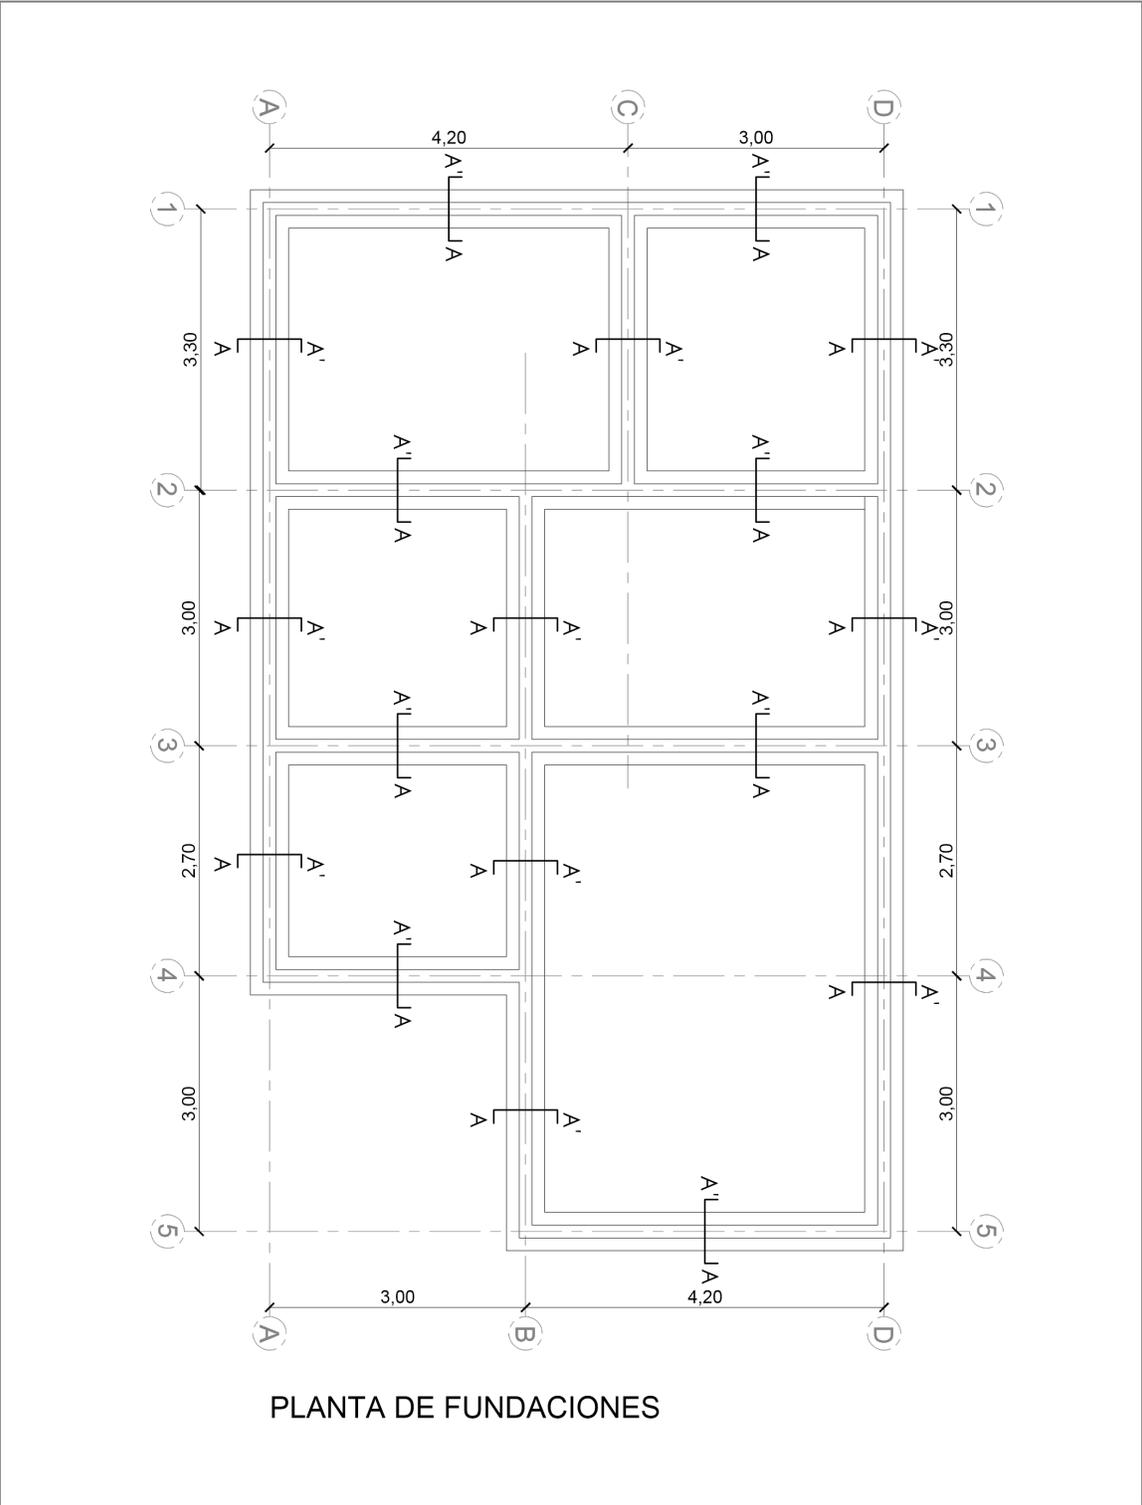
Planta de fundaciones modelo de albañilería confinada
